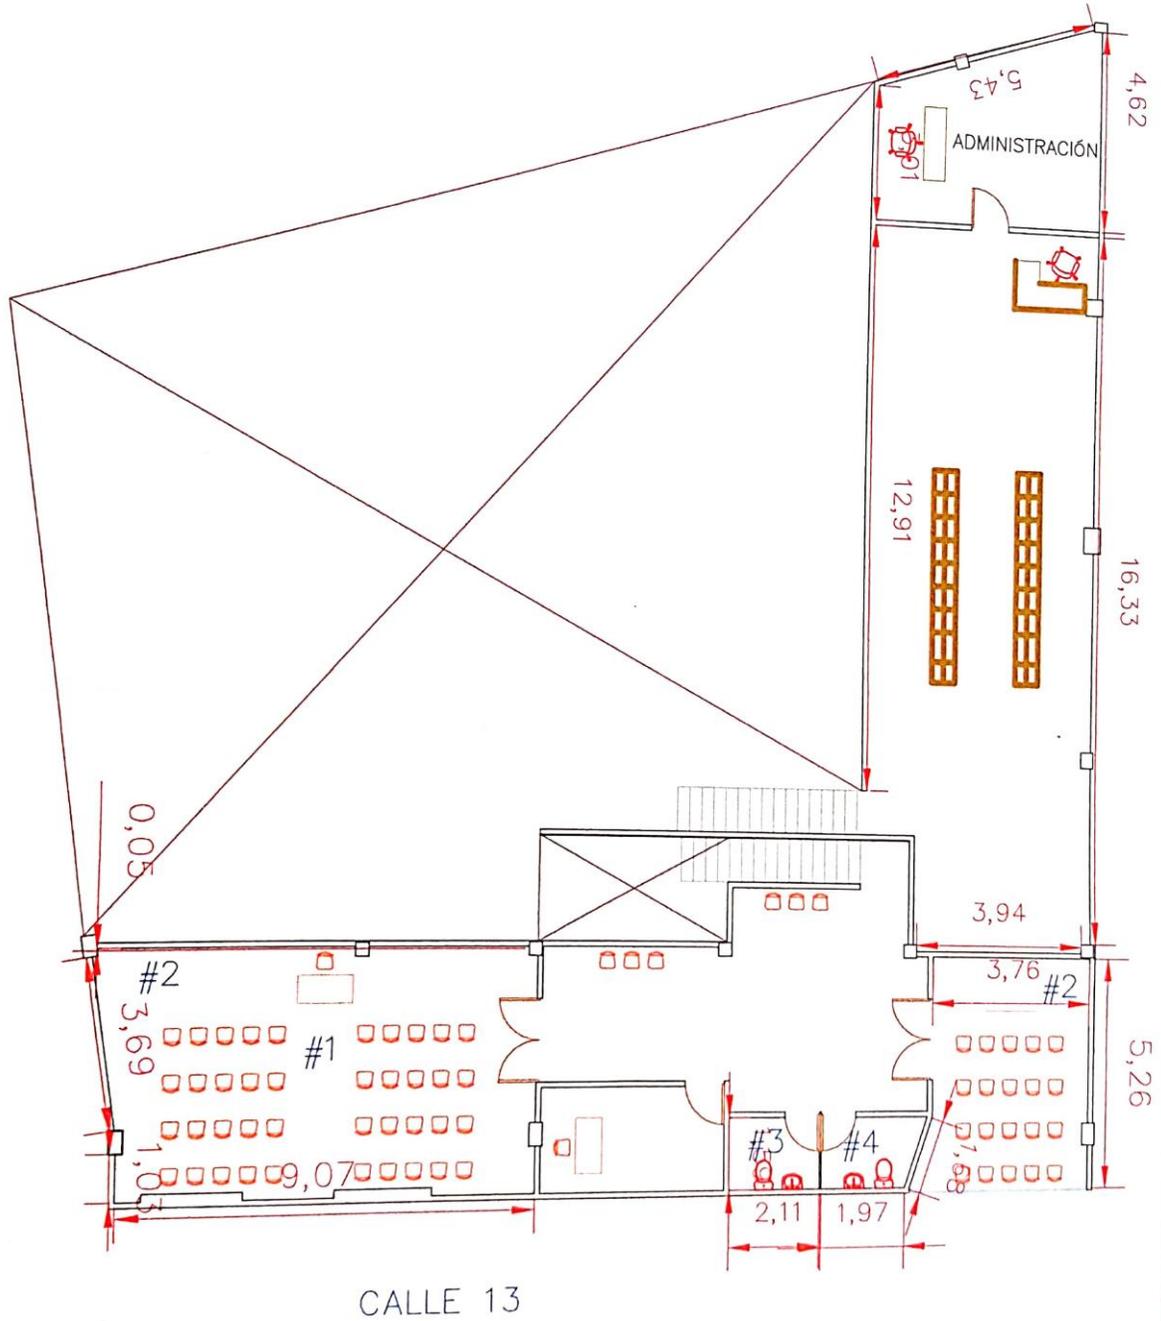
Plano arquitectónico sede CIS Sabana de Torres.
